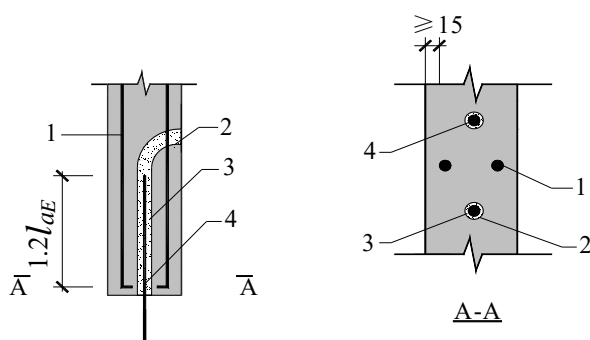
竖向钢筋单排金属波纹管浆锚搭接连接
